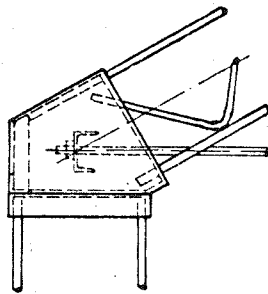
Nudos de pórticos con perfiles livianos de chapa doblada
